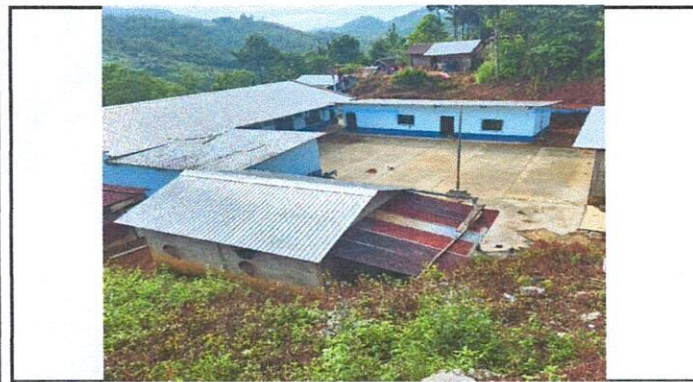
PINTURAS EN MUROS EXTERIORES E INTERIORES
